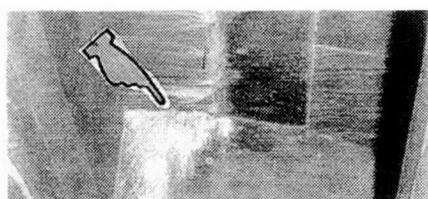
伸縮部後打ちコンクリート部分からの漏水
